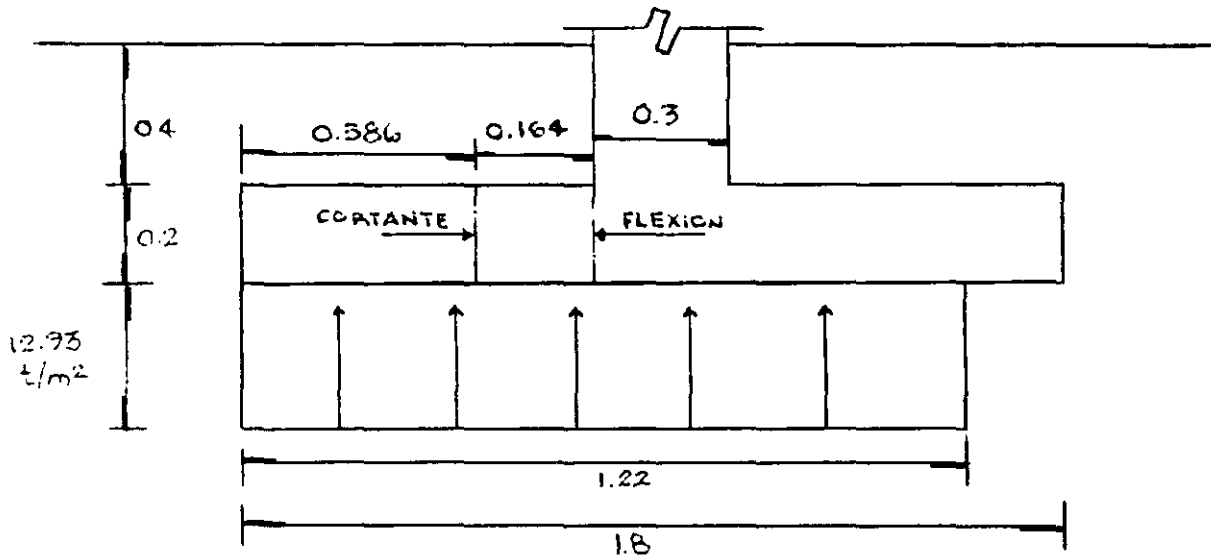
CARACTERÍSTICAS ESTRUCTURALES DE LA ZAPATA (EJEMPLO 5.3)
